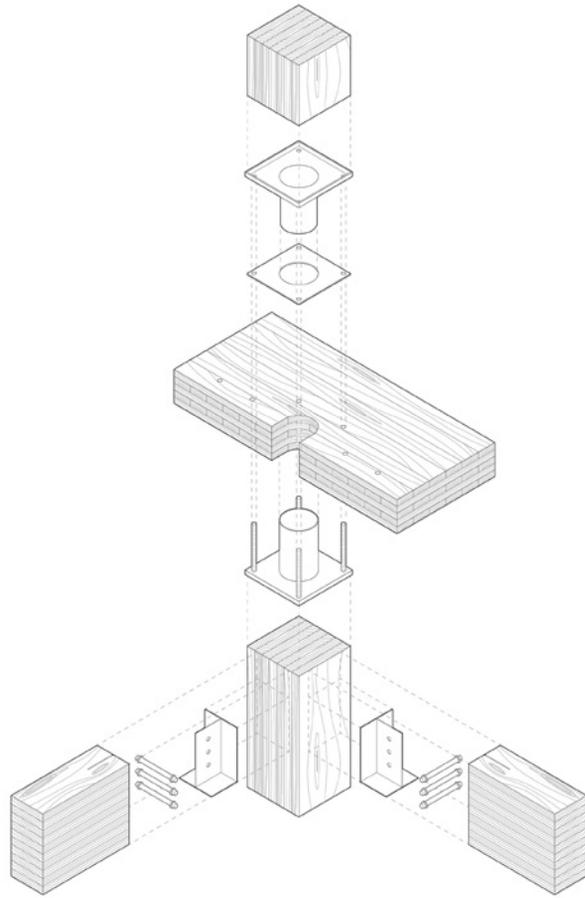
Detalle constructivo que muestra el ensamblaje de las partes de madera masiva. Fuente: elaboración propia.
